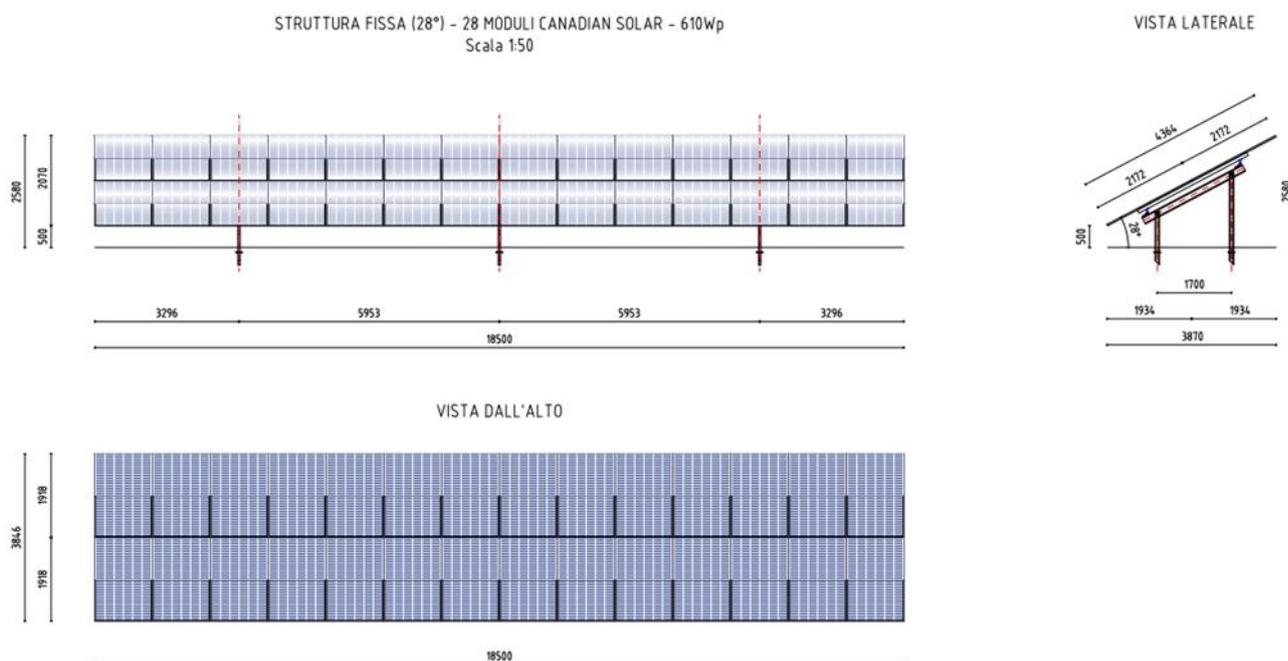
Tipico struttura supporto pannelli di tipo fisso
